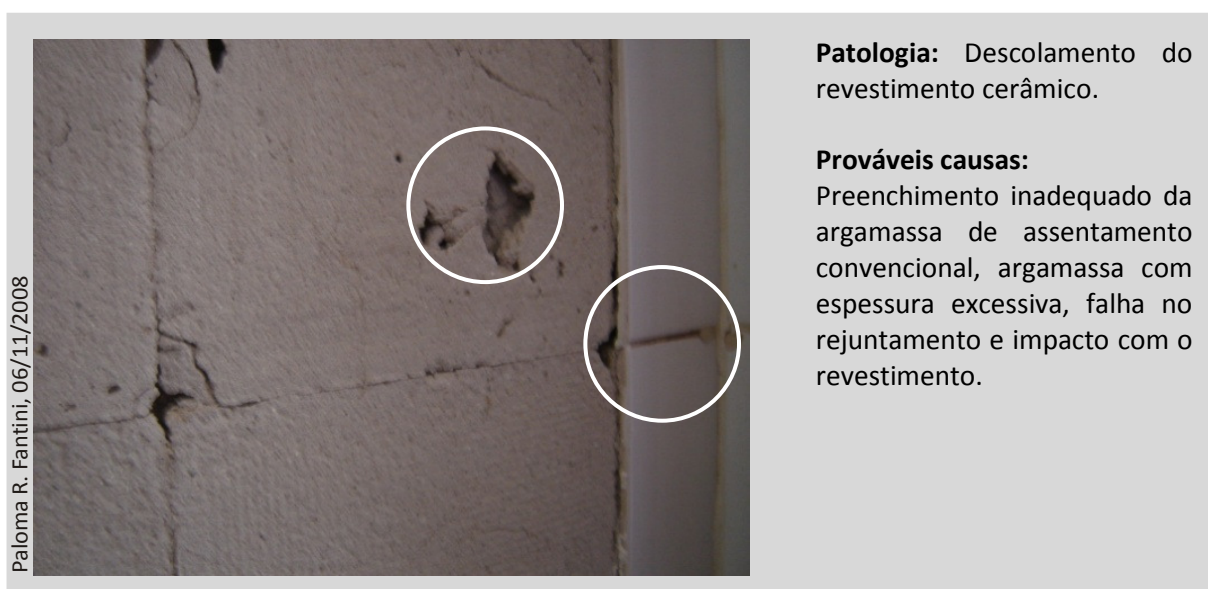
Detalhe do descolamento cerâmico – parede do banheiro
